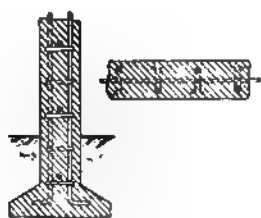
u. 30. Armierte Wand nach Hennebique.
